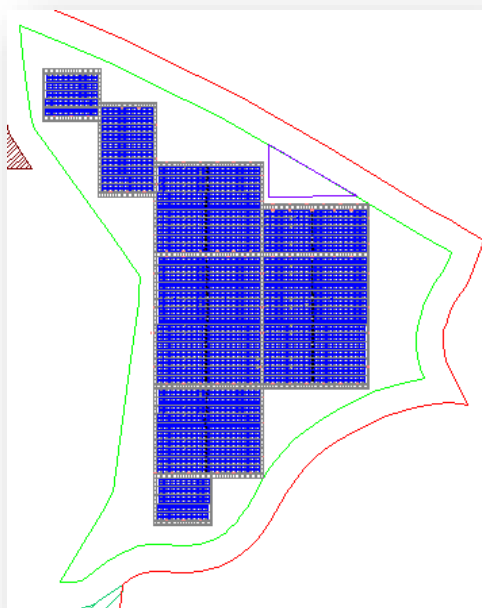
Plan d'implantation de la centrale photovoltaïque flottante en utilisant des structures flottantes Ciel&Terre
